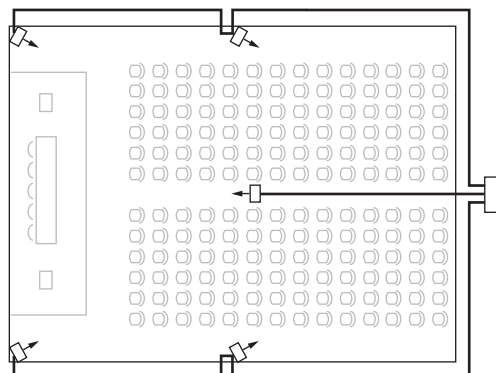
Disposição simétrica do cabeamento do radiador (recomendada)
